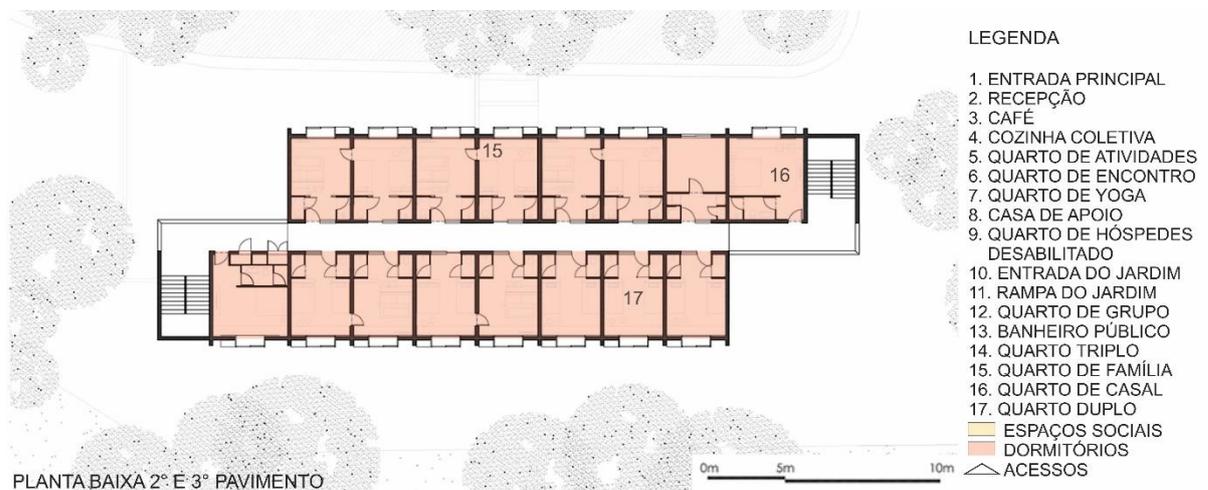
Albergue iD Town: planta segundo e terceiro pavimento. FONTE: DESIGNBOOM (2015, adaptada pela autora).
